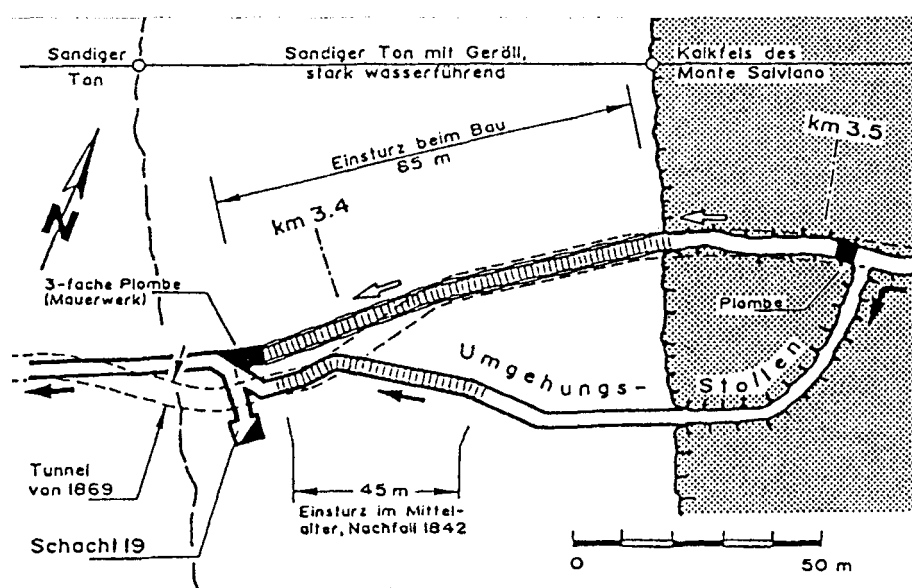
Avezano, Claudius- Tunnel am Fucinersee. Eine Einsturzstelle wurde mittels Bypass umfahren (n. Brissel Rotrou 1883)
